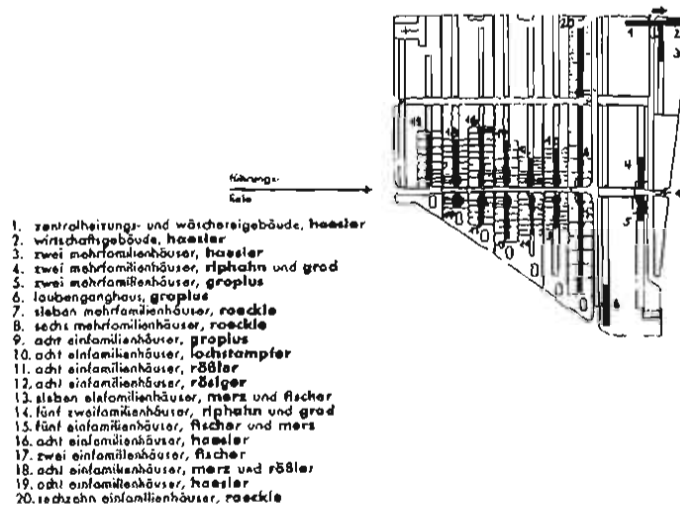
Siedlung Dammerstock, Lageplan der Bauausstellung im Jahr 1929
